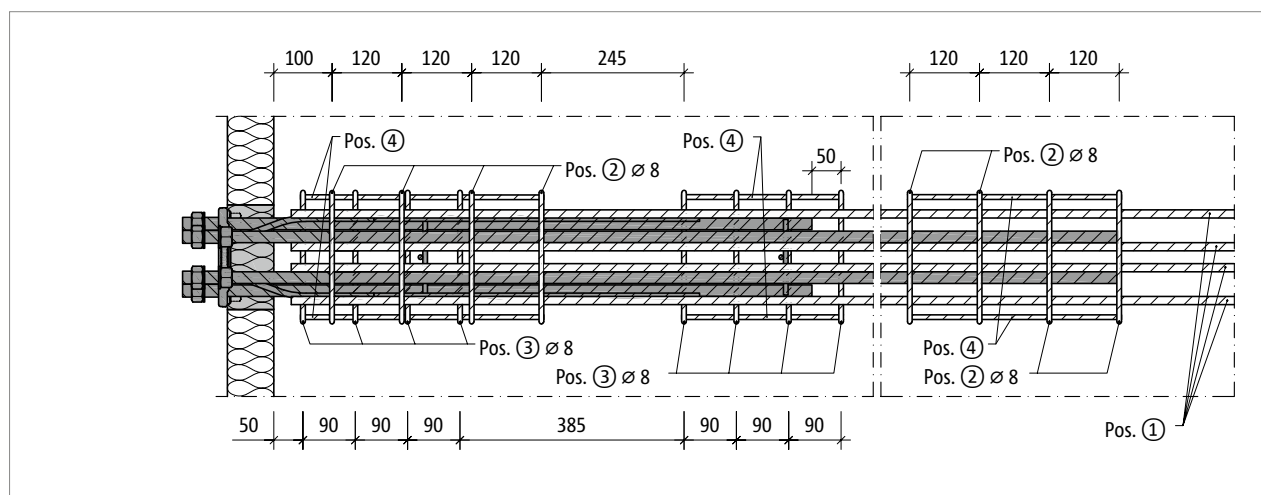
Schöck Isokorb® T Typ SKP-MM2: Bauseitige Bewehrung, Grundriss
